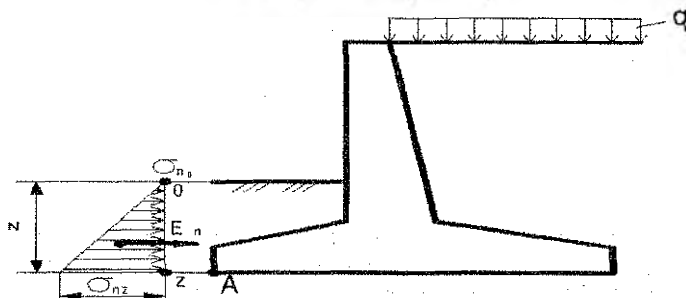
Схема к определению пассивного давления сыпучего грунта на подпорную стенку
